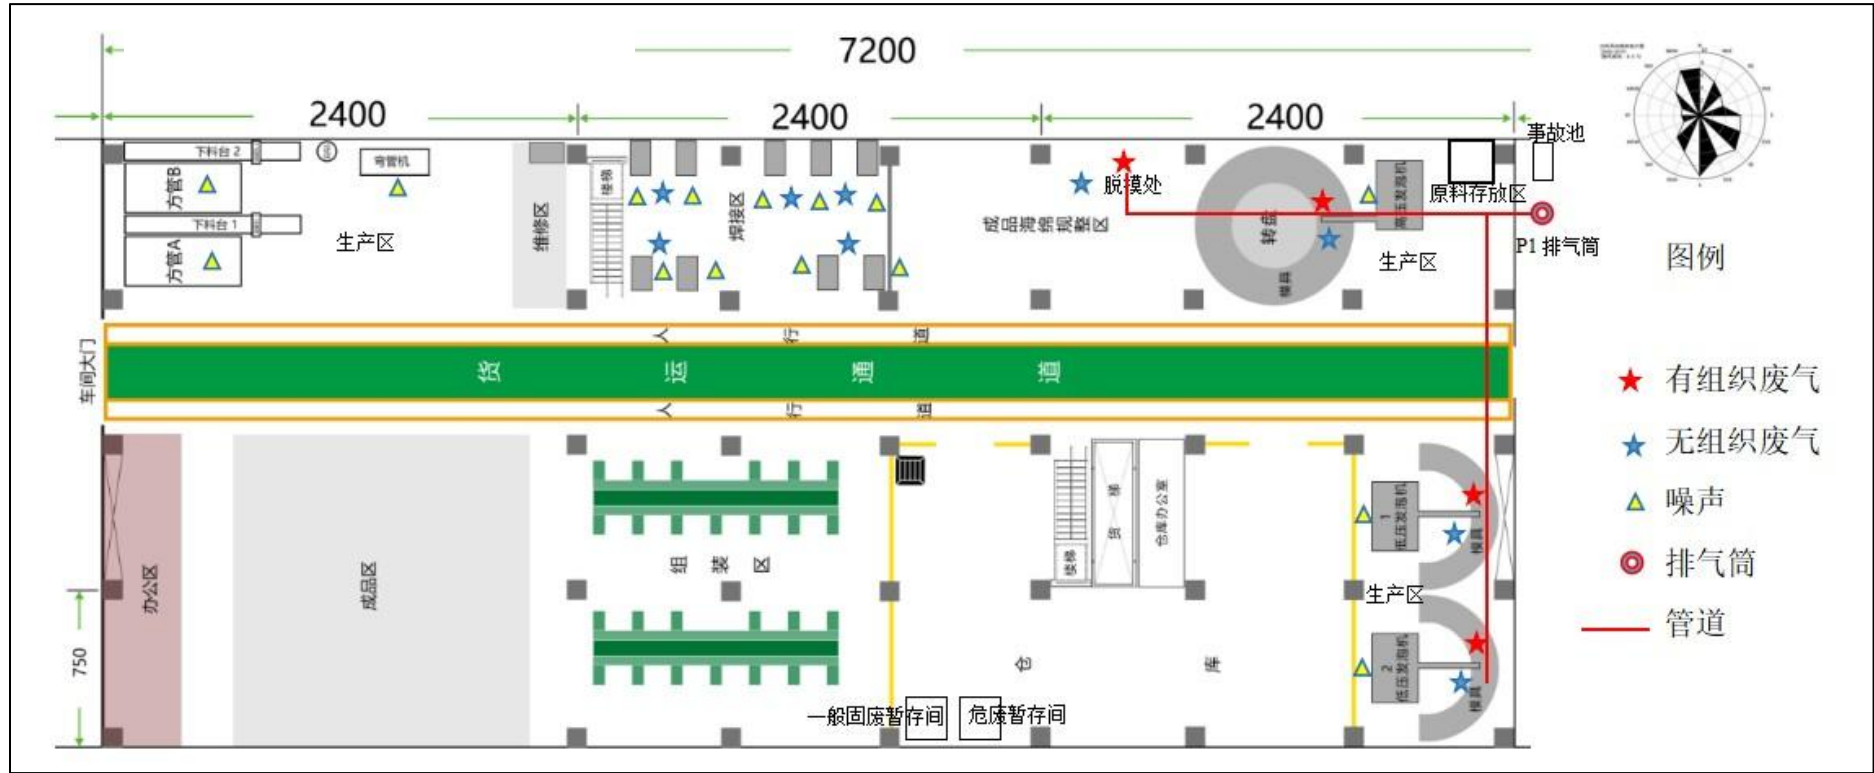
环评-生产车间 1 层平面布置图 (1:500)
